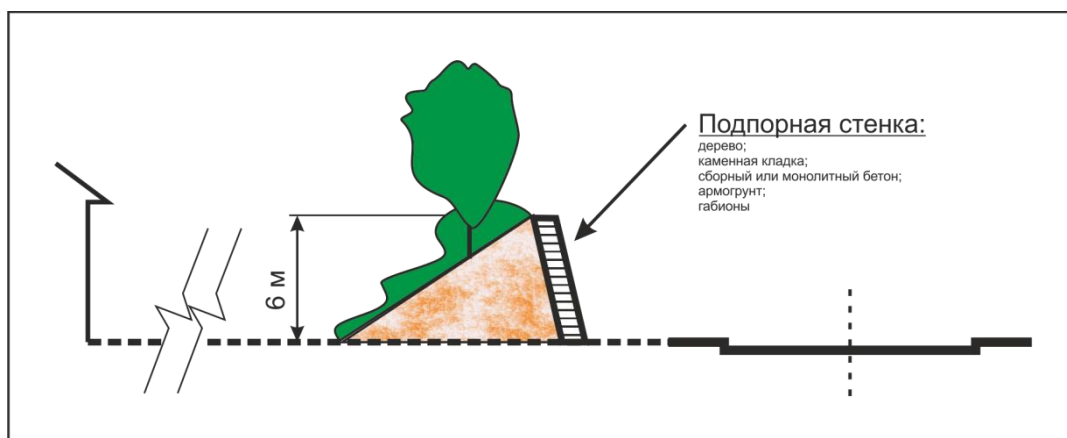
Сочетание грунтового вала с подпорной стенкой
